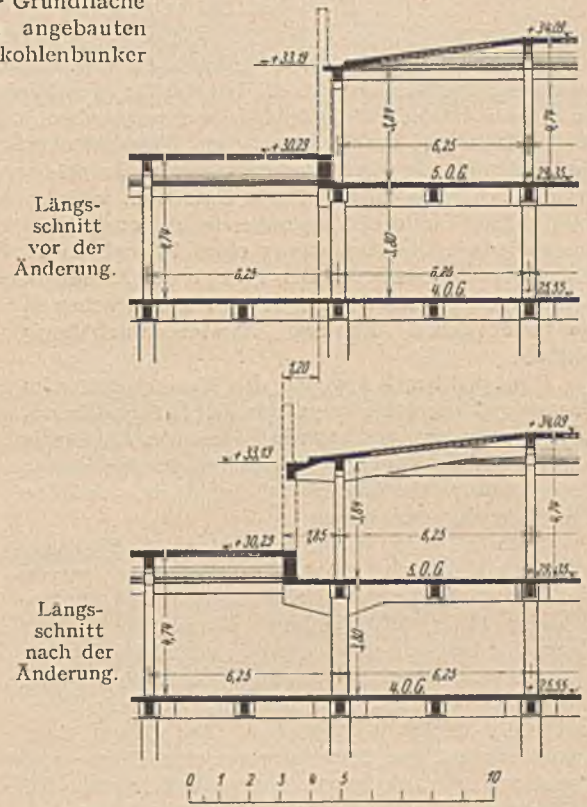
Änderungen im Dachgeschoß des Hauptgebäudes.
